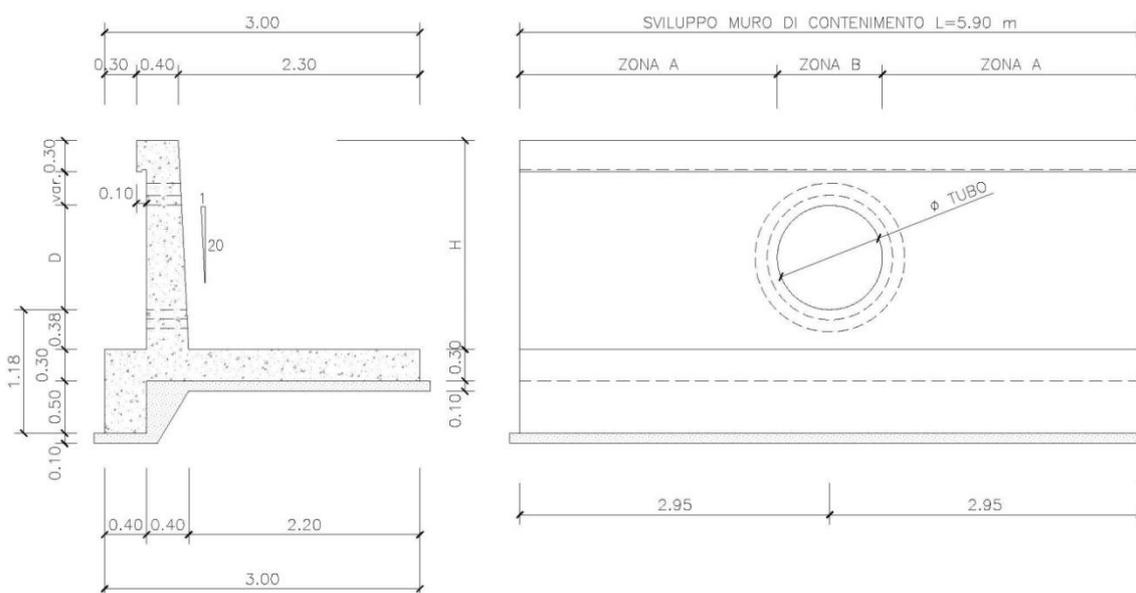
Sezione longitudinale e trasversale tipologica muro di imbocco / sbocco
